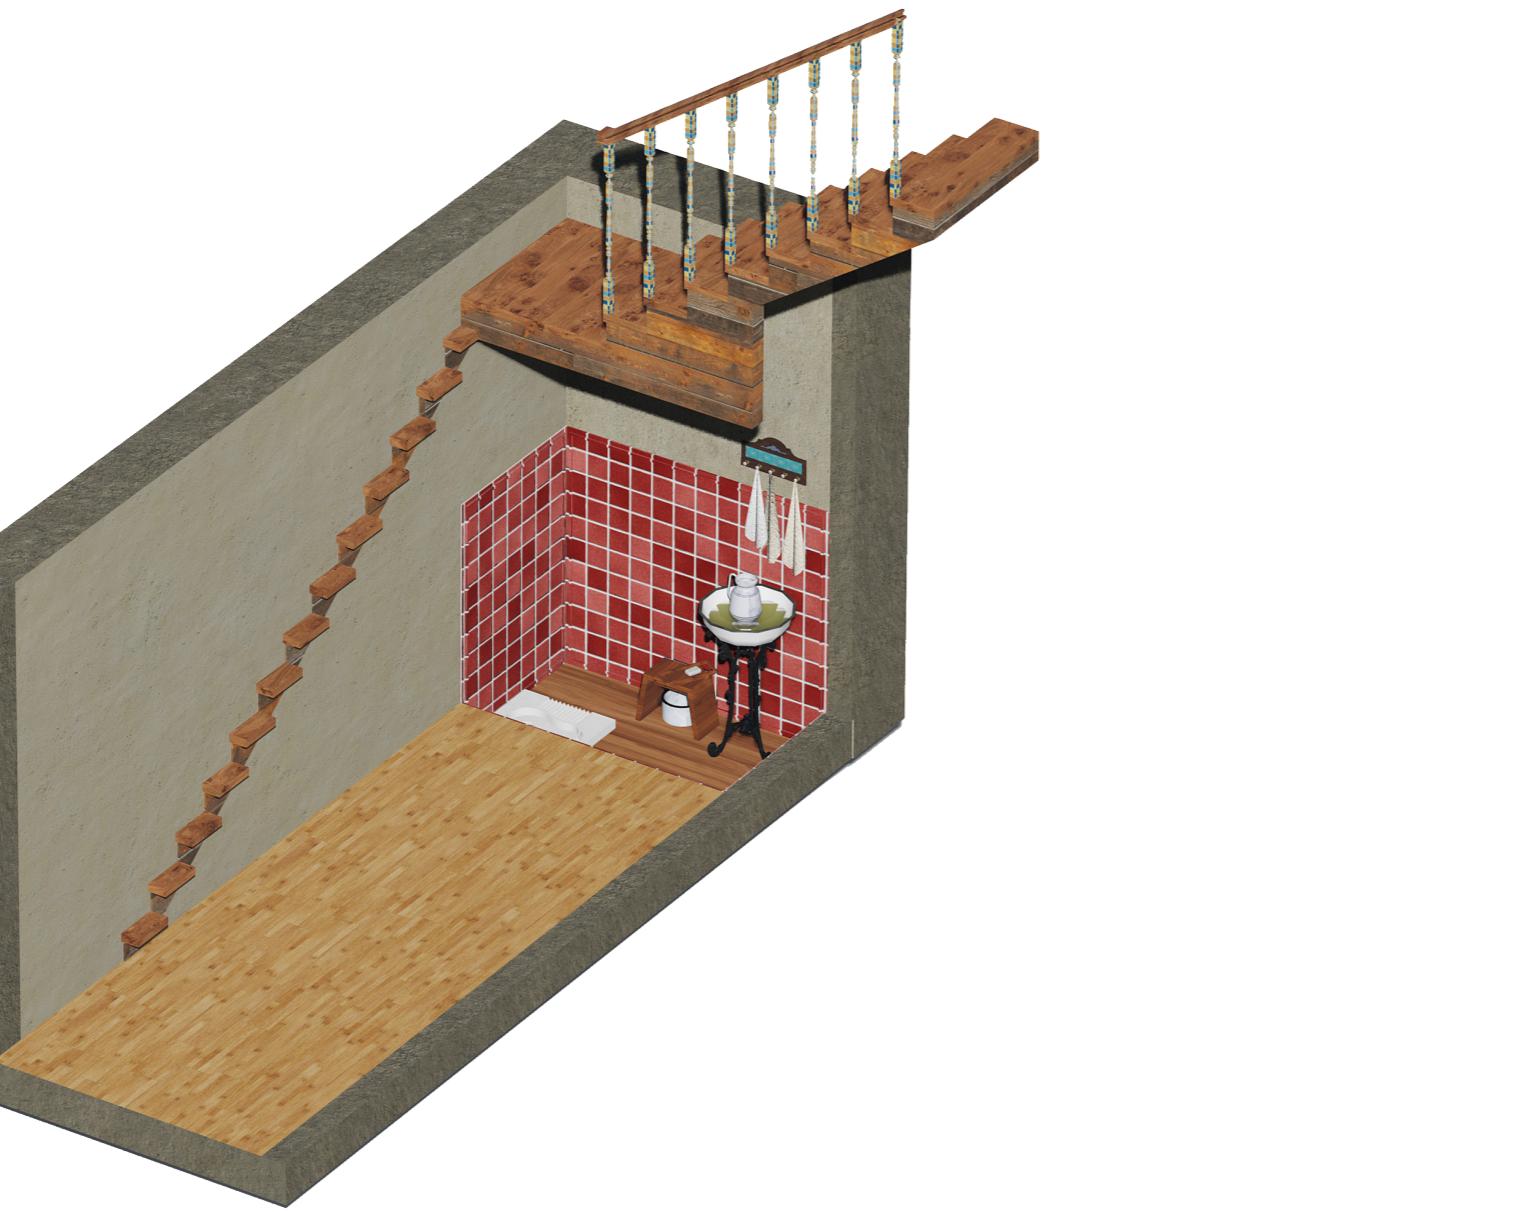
Perspectiva vivienda Rodríguez Planta Baja
